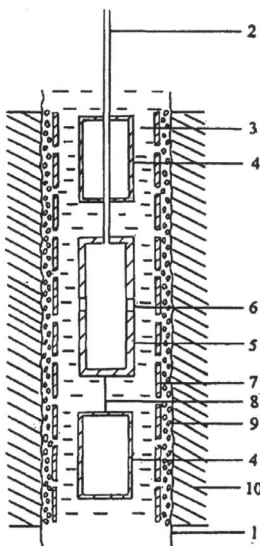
Пристрій для депресійної обробки фільтра і прифільтрової зони свердловини:
